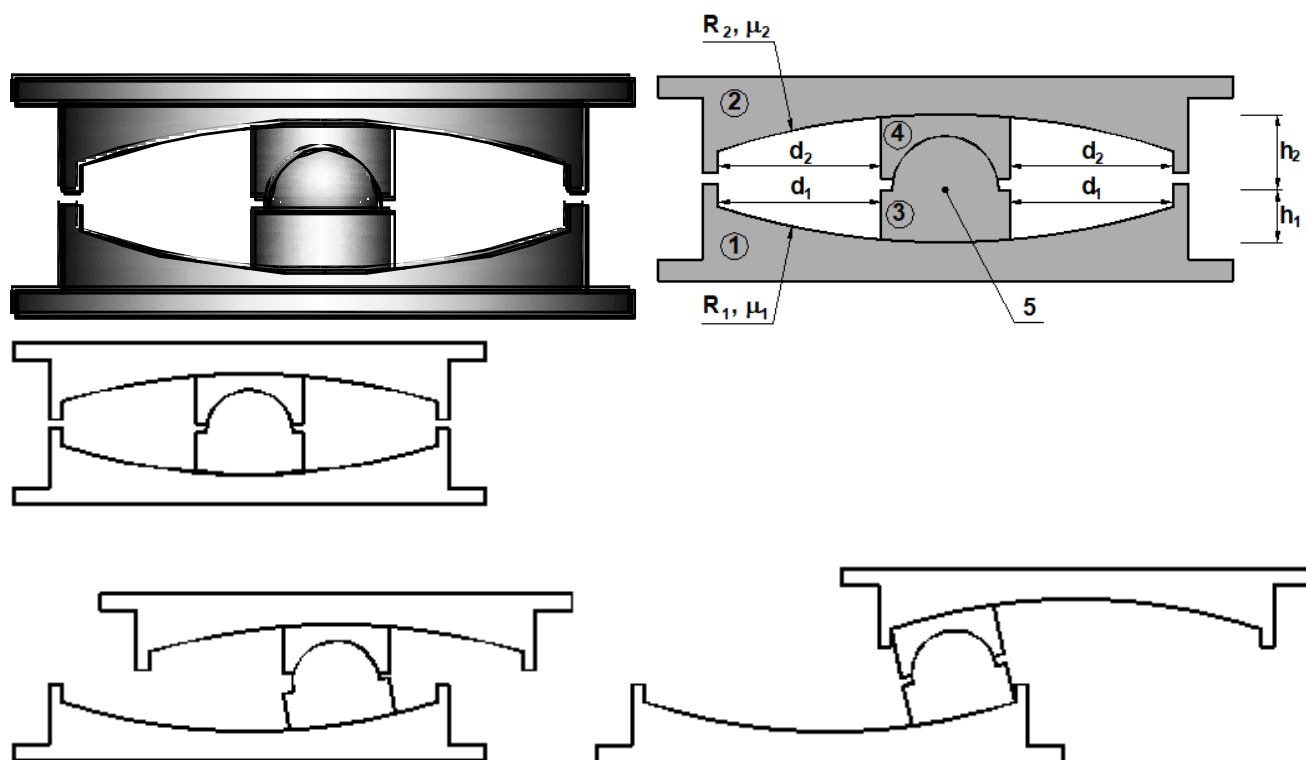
Общий вид и схема поведения двухмаятниковой скользящей опоры
